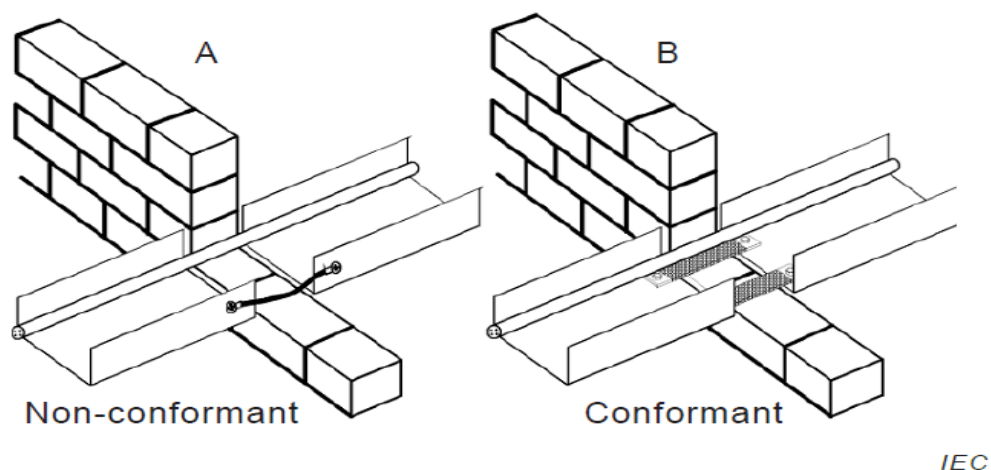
esempio di interruzione della canalina a causa di un muro
